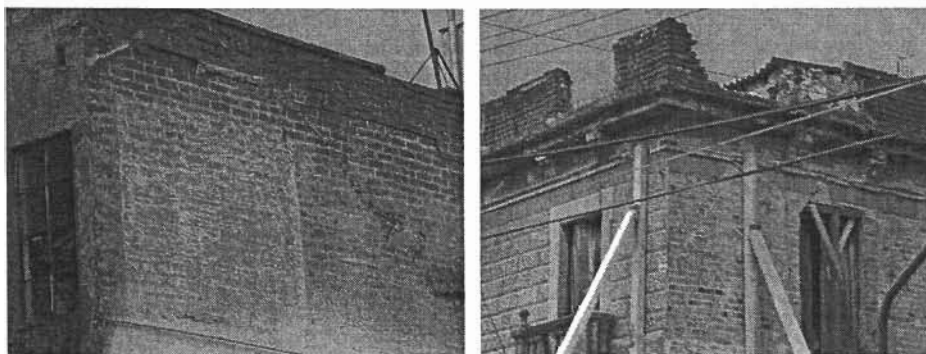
Mampostería sin refuerzo con unidades manufacturadas
